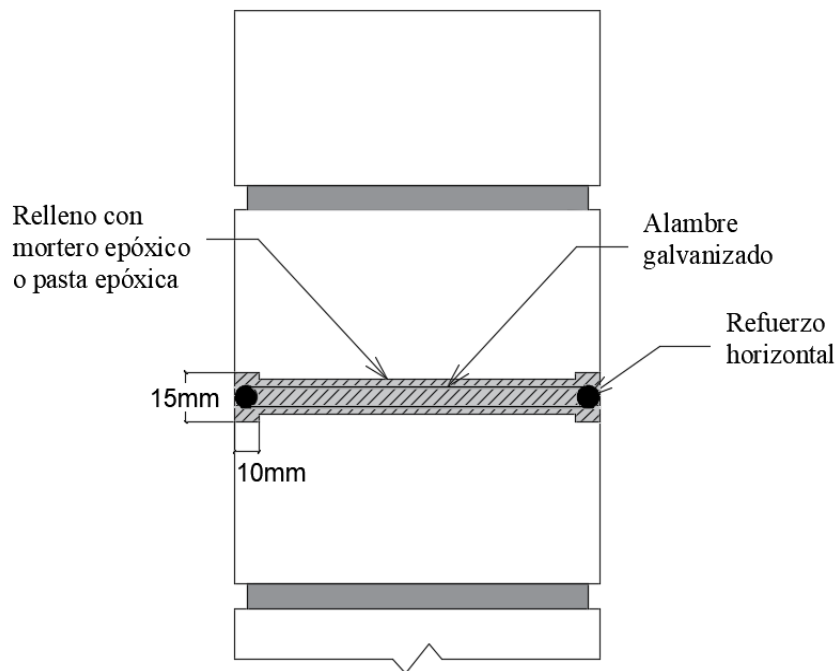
Inserción de barras de refuerzo en muro de mampostería
